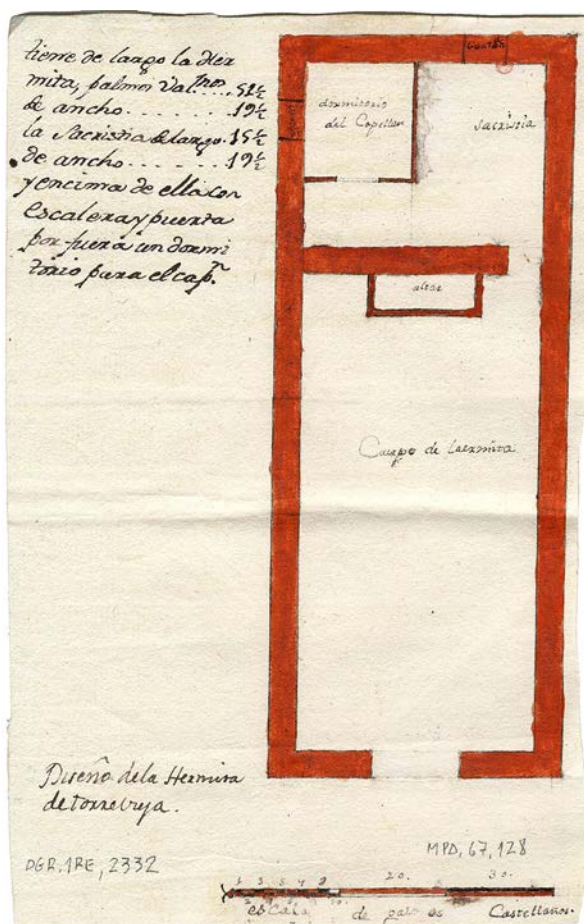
Planta de la ermita de Torre Vieja (Alicante). 1772.
